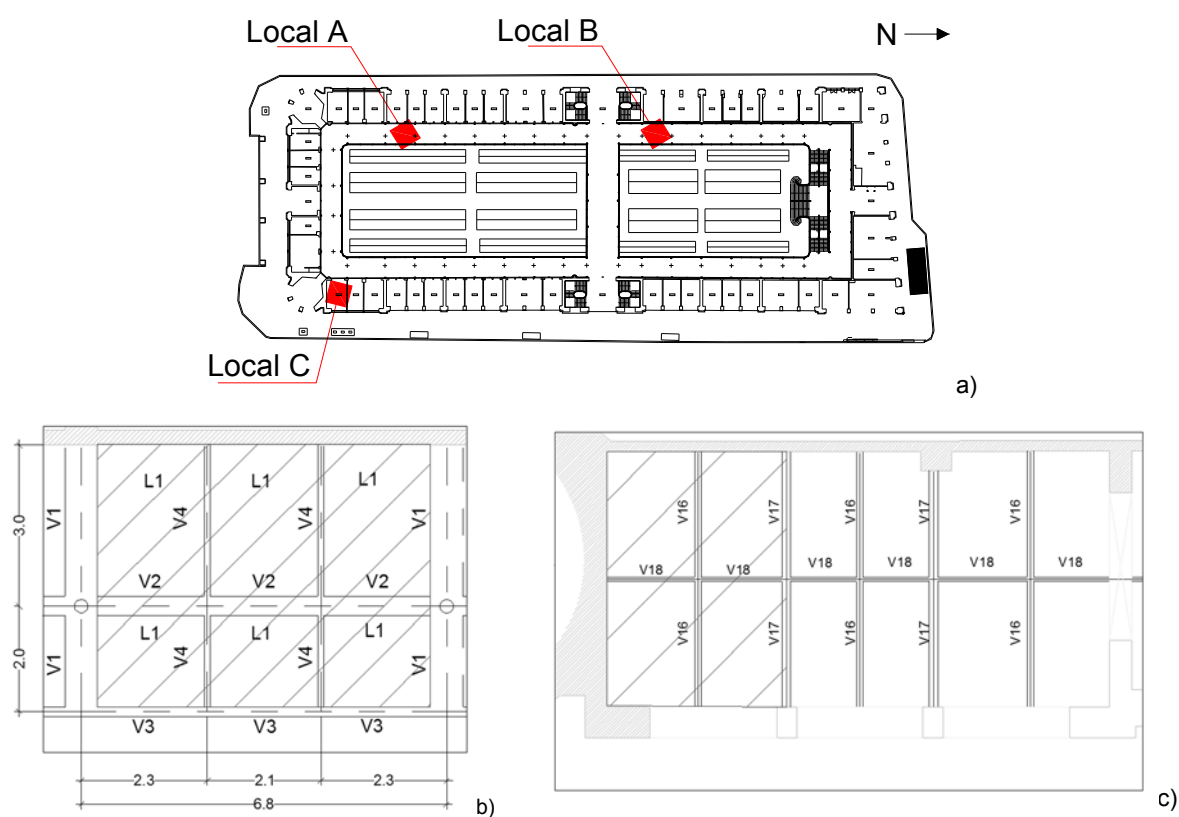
Locais de ensaio do pavimento do piso 1: a) Implantação geral; Esquemas estruturais b) dos locais A e B (na galeria) e c) do local C (loja na ala Nascente)
